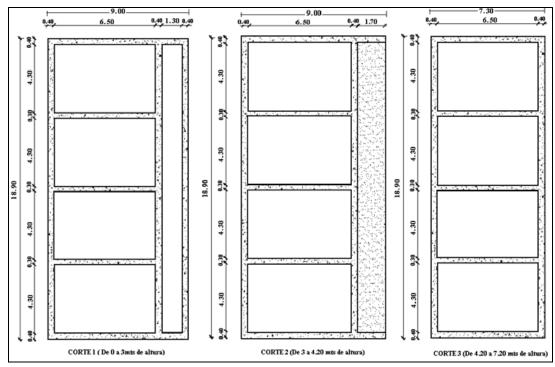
Vista en planta de los Cortes 1, 2 y 3.
